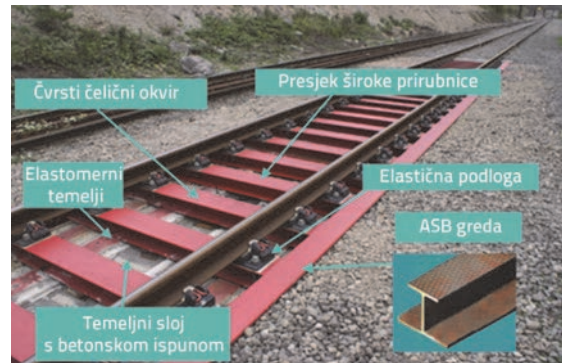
ERS (eng. *Embedded rail system*) kolosiječna konstrukcija
